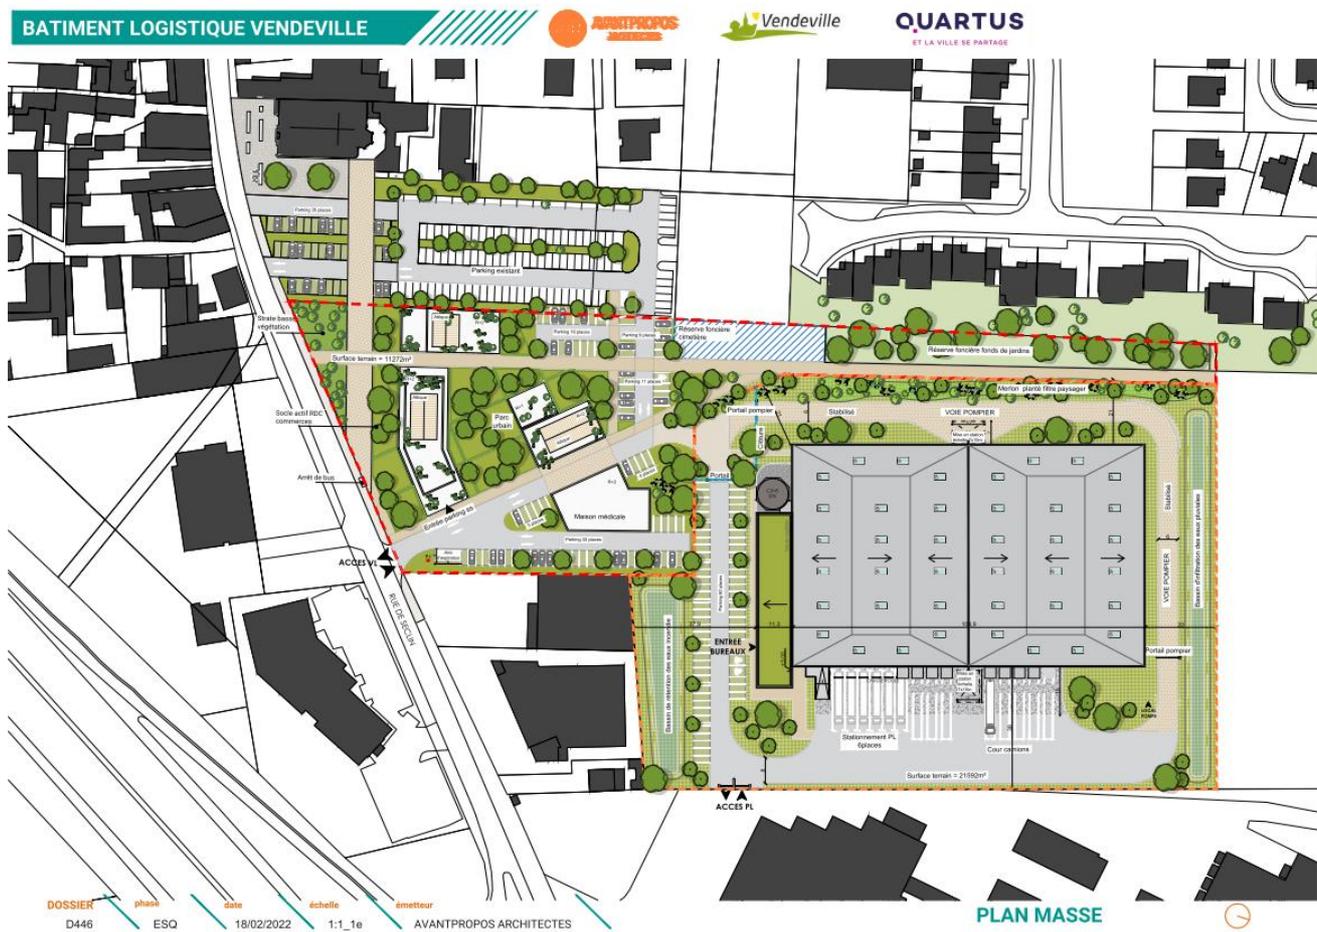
Plan masse du projet de rénovation et construction d'un bâtiment logistique
